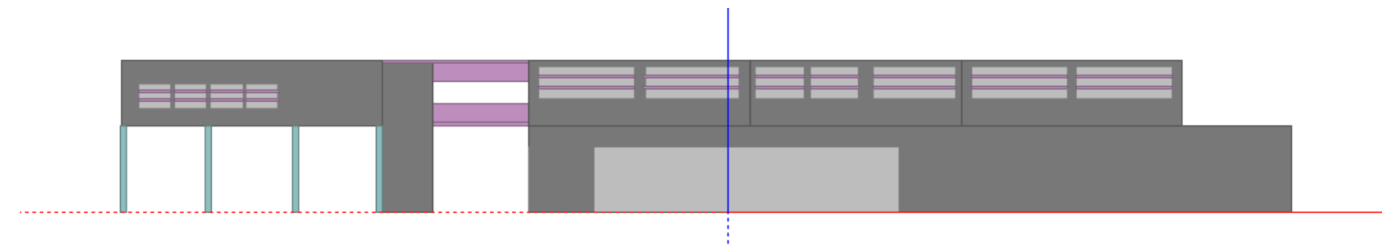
Alzado Este. Elaboración propia en Design Builder.
